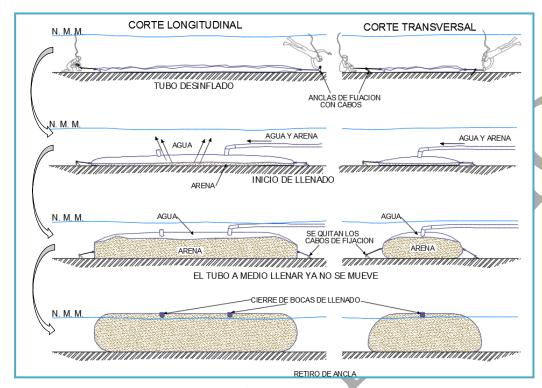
Proceso típico de llenado de elementos de geotextil para rompeolas y sección ciega bajo muelle existente.
